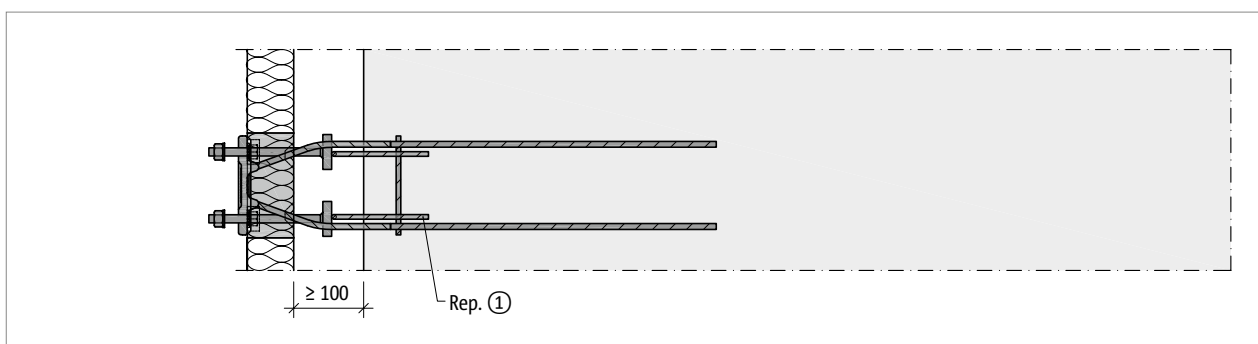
Schöck Isokorb® T type SQ : renforcement sur site pour construction semi-préfabriquée, plan de base
